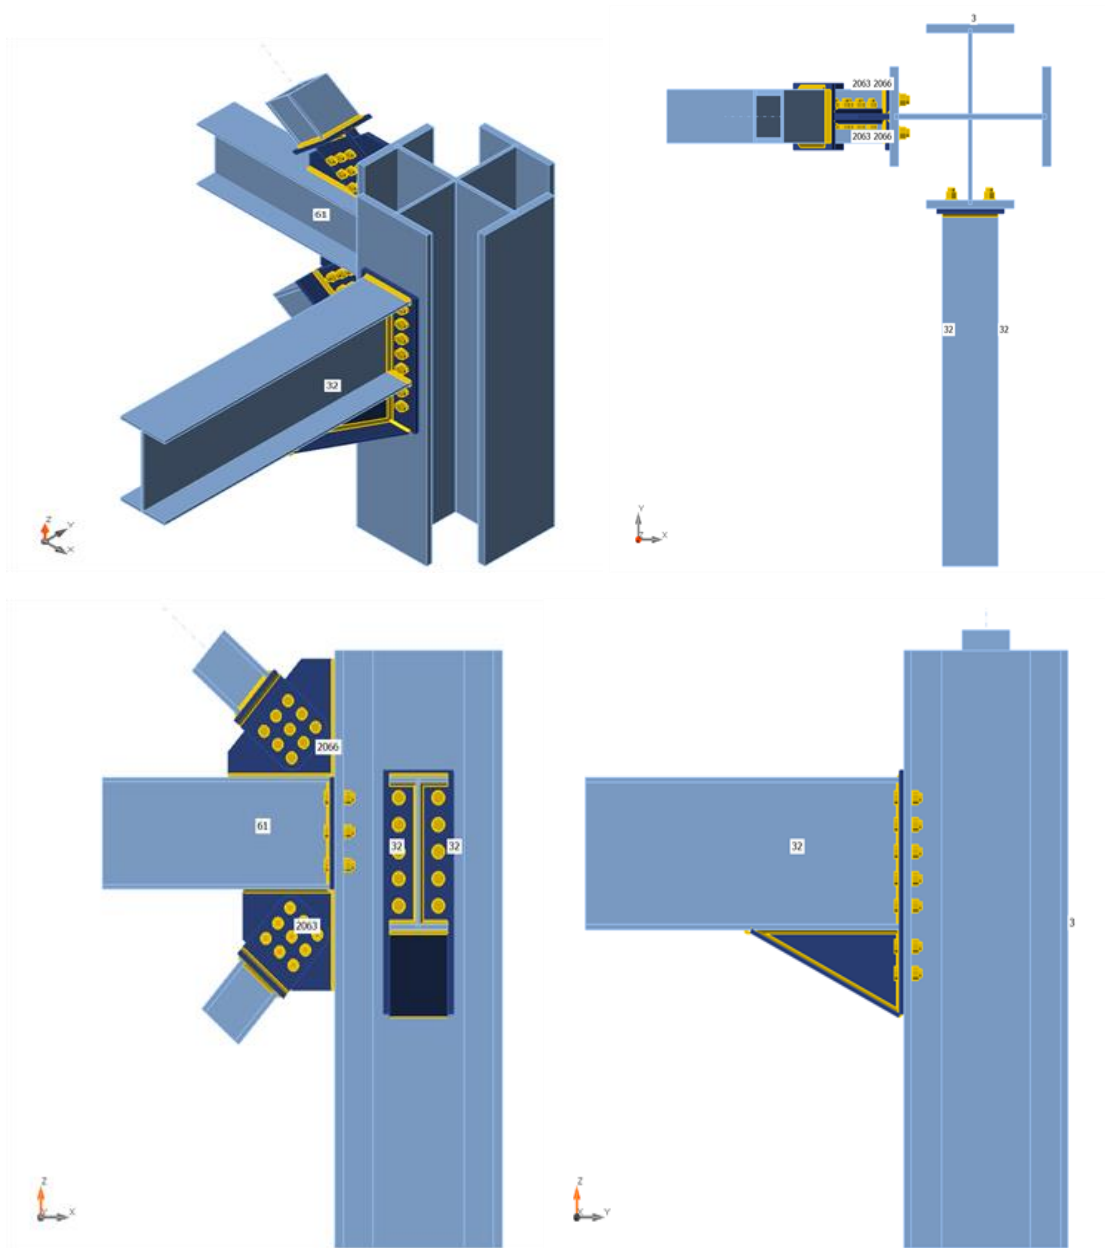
Vue d'assemblage poutre-contreventement-poteau.
